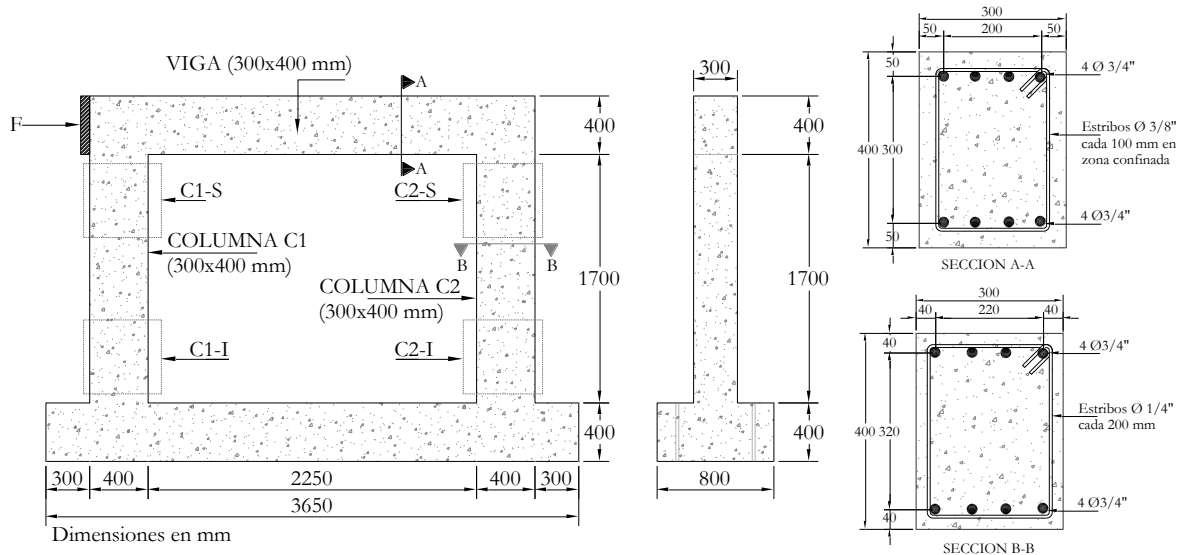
Geometría y secciones de viga y columna pórtico P2
